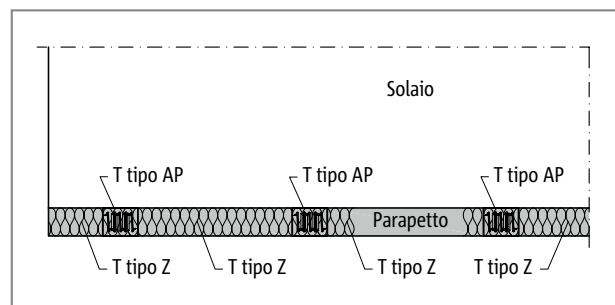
Schöck Isokorb® T tipo AP disposizione verticale: pianta parapetto sovrapposto
